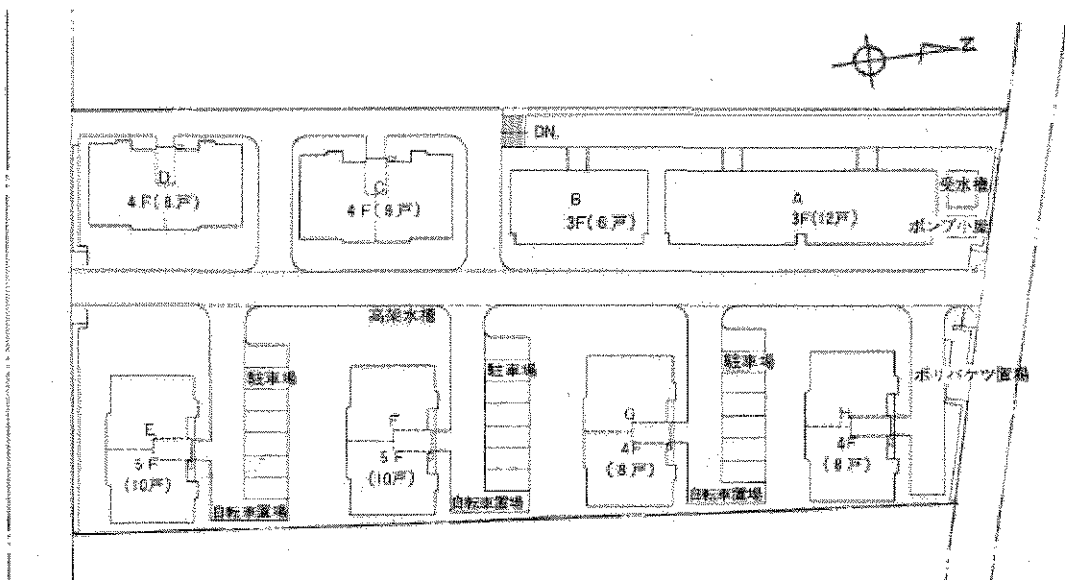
市ヶ谷加賀町アパート 全体配置図
